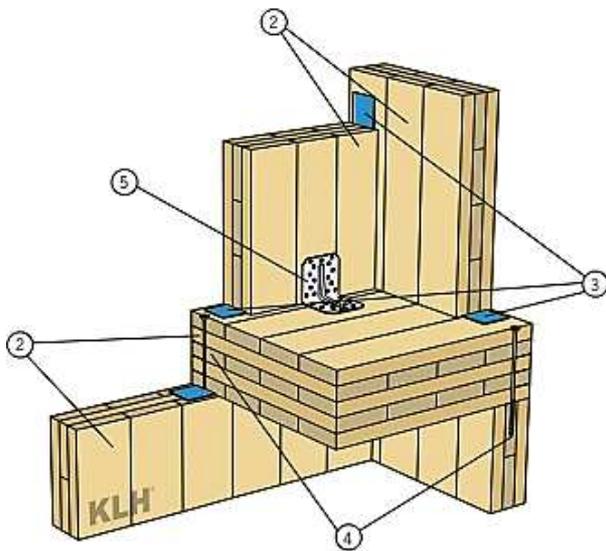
Ligação parede c/ soleira elevada (ligação placa metálica e parafusos roscados) [24]
